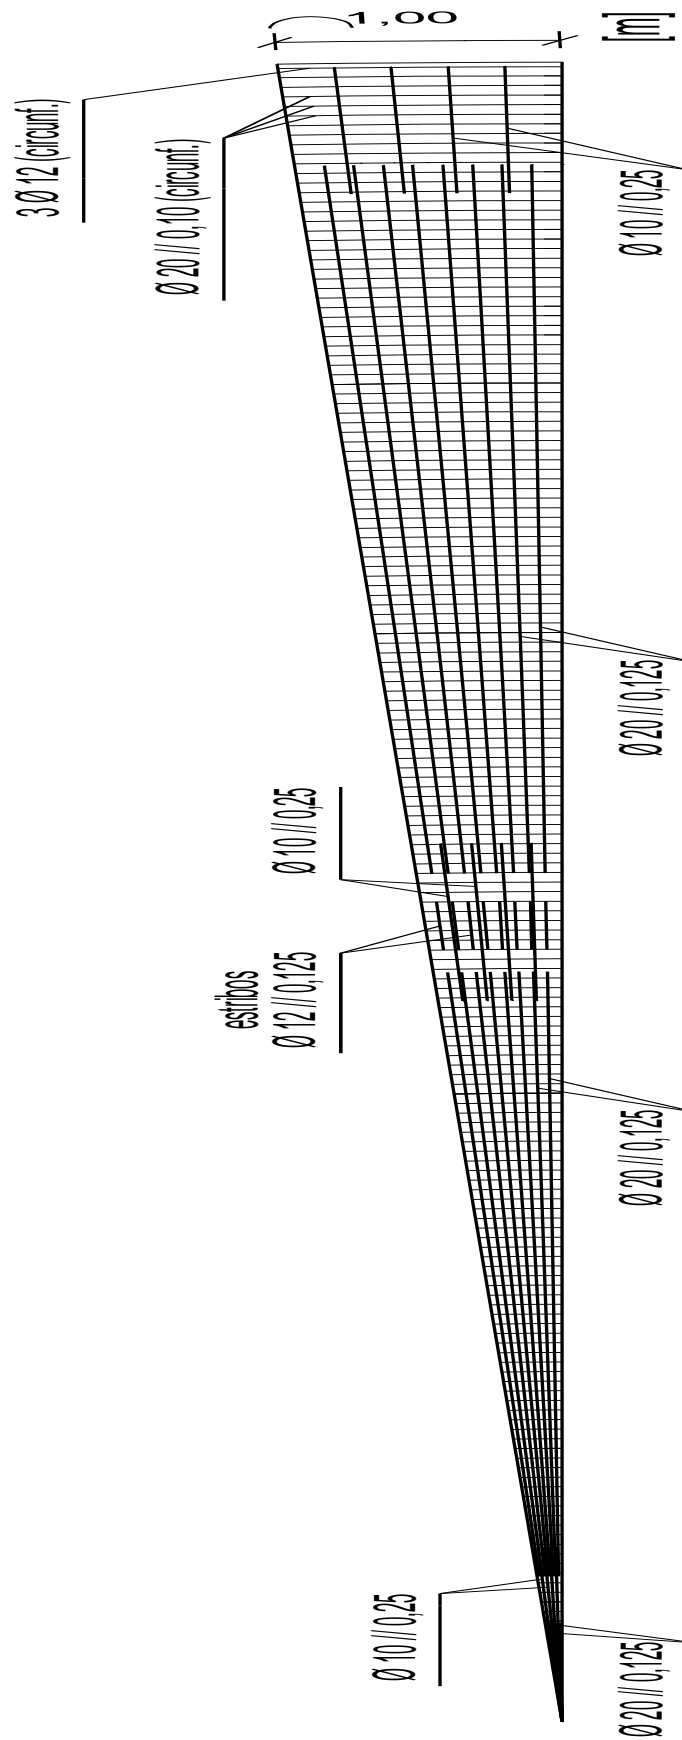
Armadura inferior da laje de fundo (representação por metro de faixa de laje).
